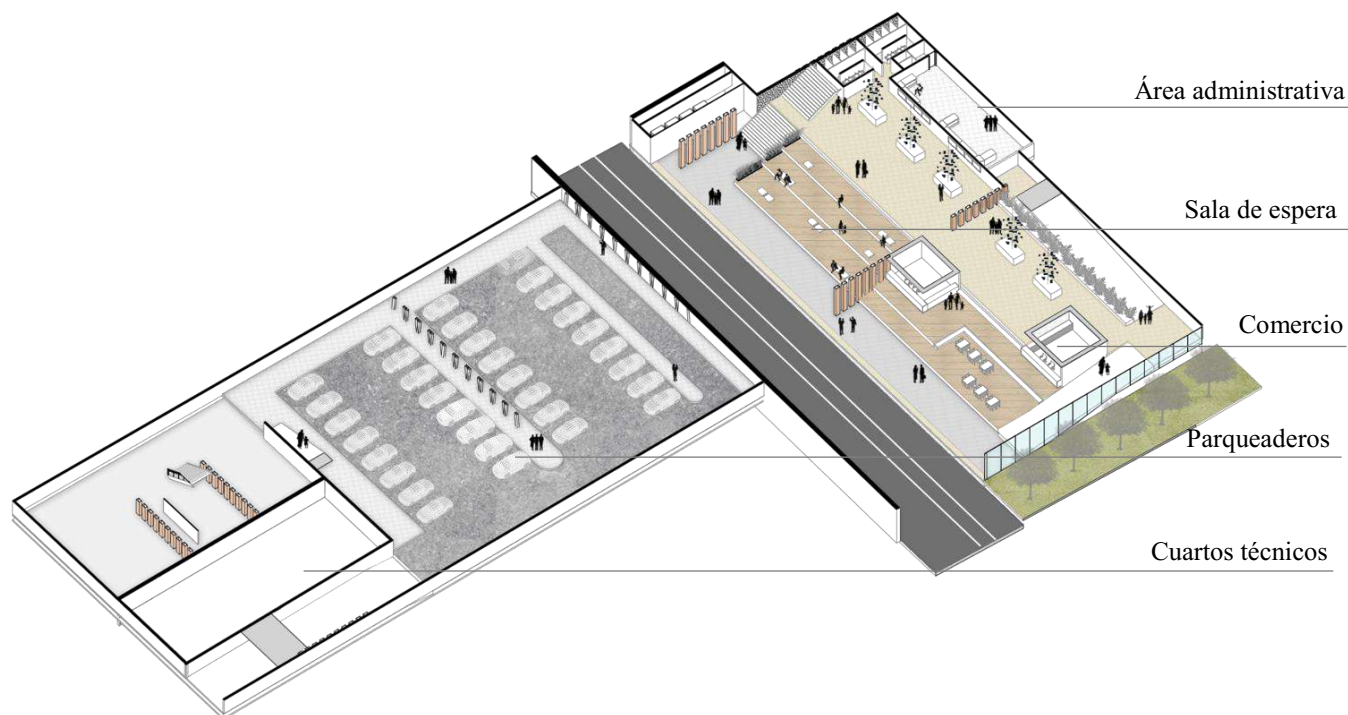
Planta axonometría nivel inferior. Elaboración propia.
